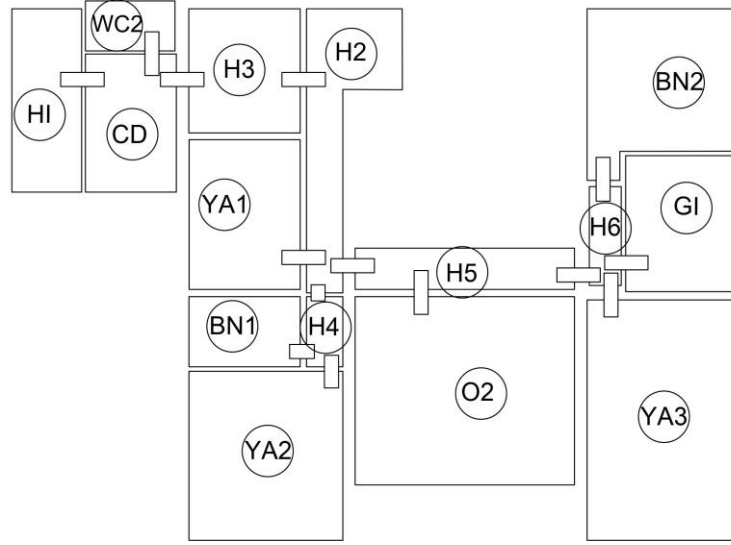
Suna Kıraç Yalısı giriş kat planı
